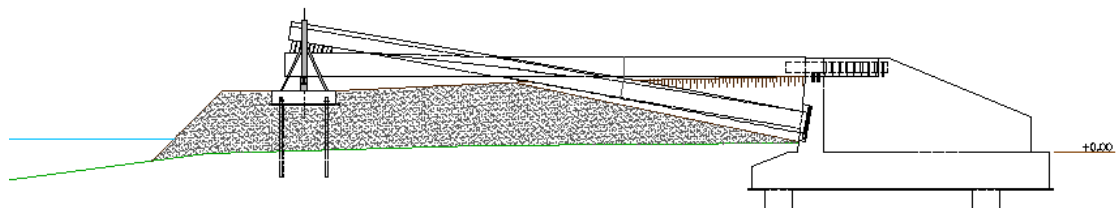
Alzado frontal. Sección Colocación primer tramo de arranques.
